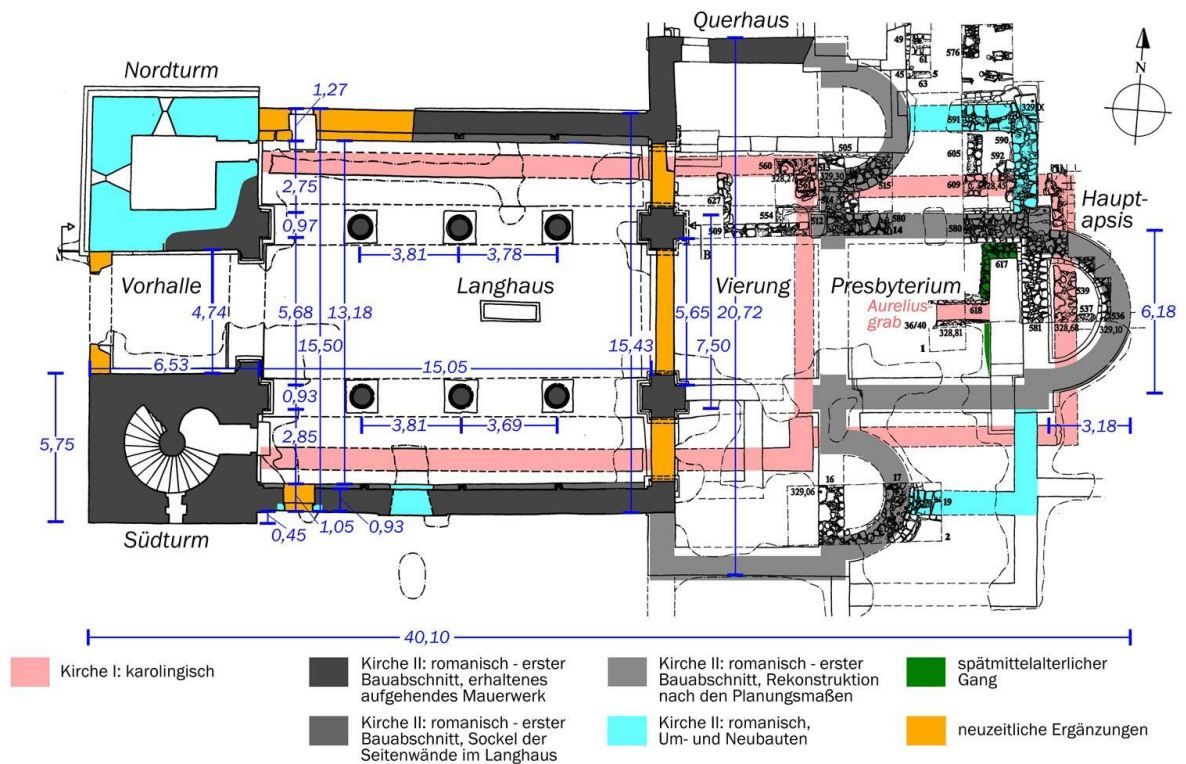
Hirsau, Aureliuskirche, Grundriss und Grabungsbefunde
